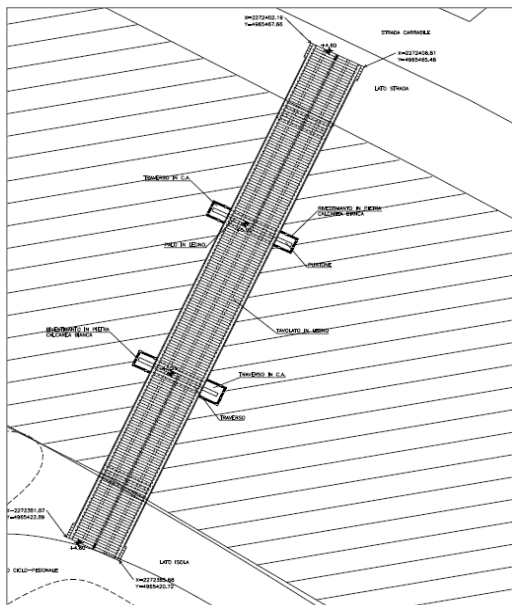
Planimetria passerella ciclo-pedonale da progetto PREGRESSO
